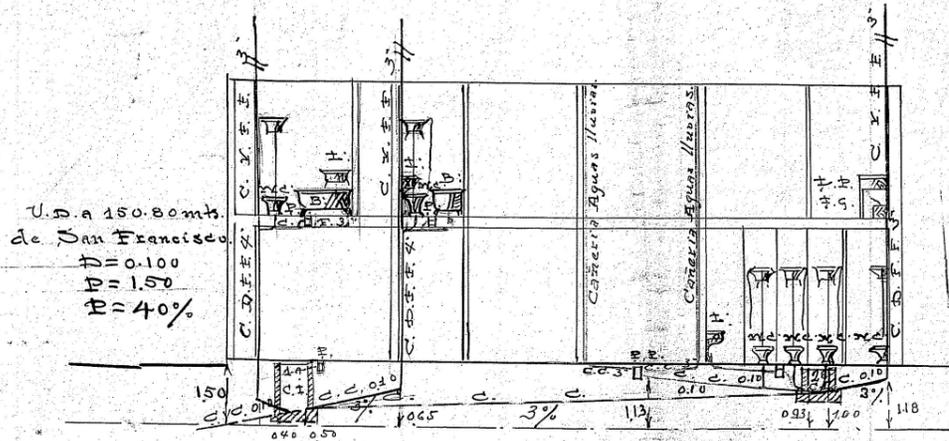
Plano de alcantarillado de 1914 del caso 1.
